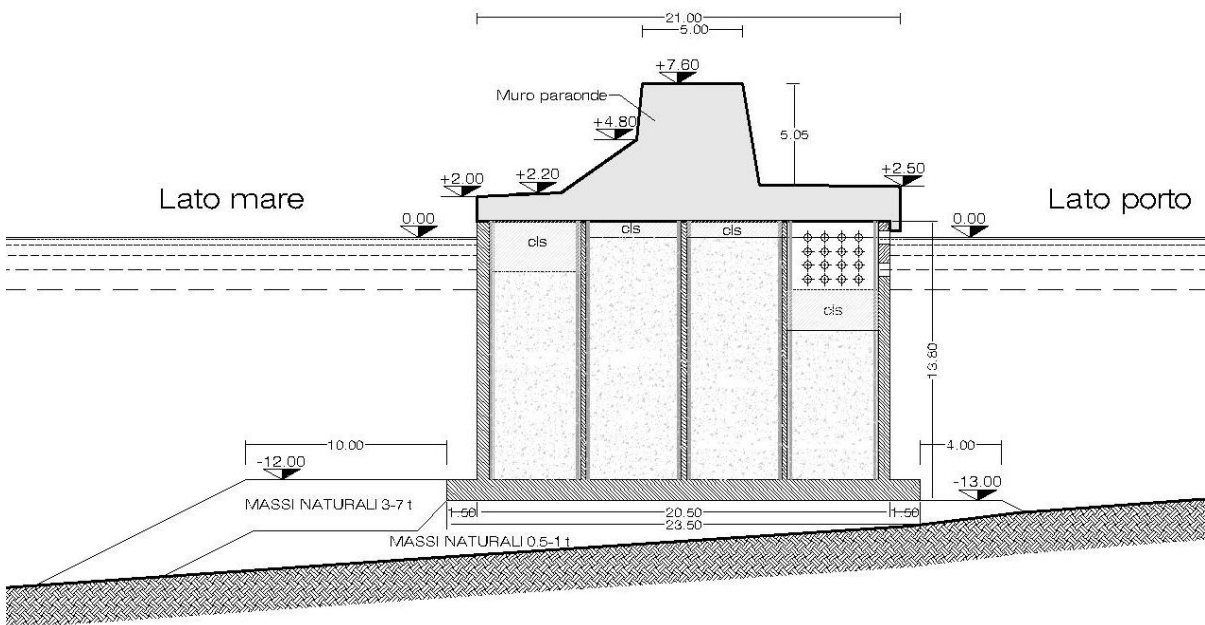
Diga foranea. Sezione tipo del tratto di opera a parete verticale
